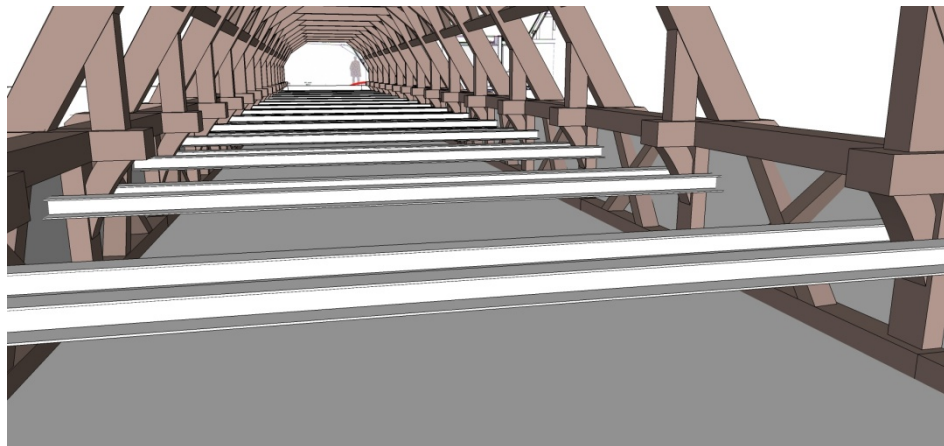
Les poutres IPE fixés dans la maçonnerie.
